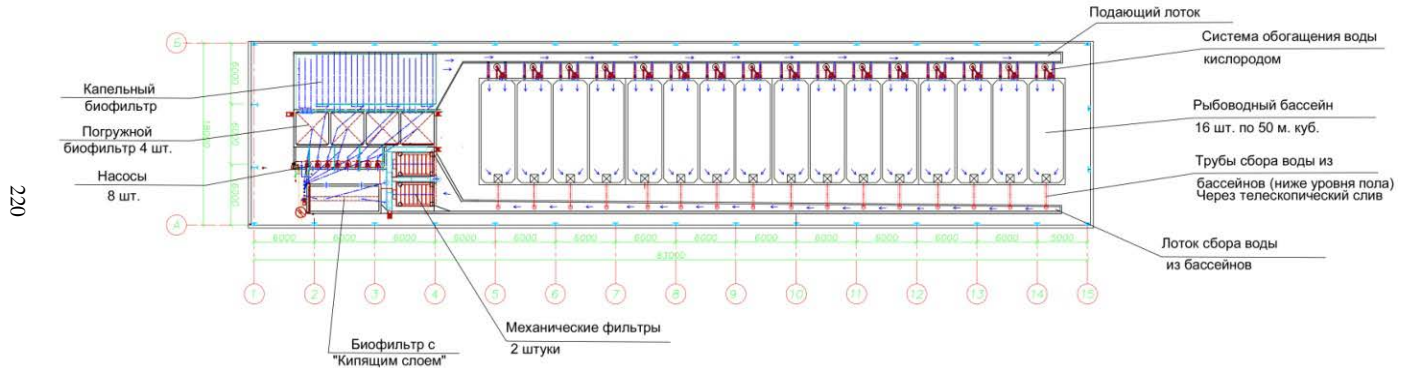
Схема УЗВ с бетонными прямоугольными бассейнами (вариант 5) для выращивания осетровых
